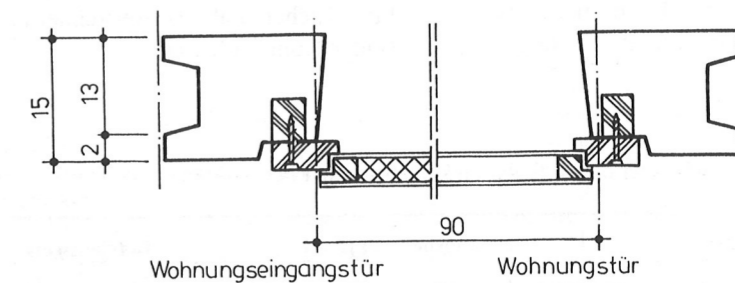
Anschluß Türrahmen an Betontüргewände
